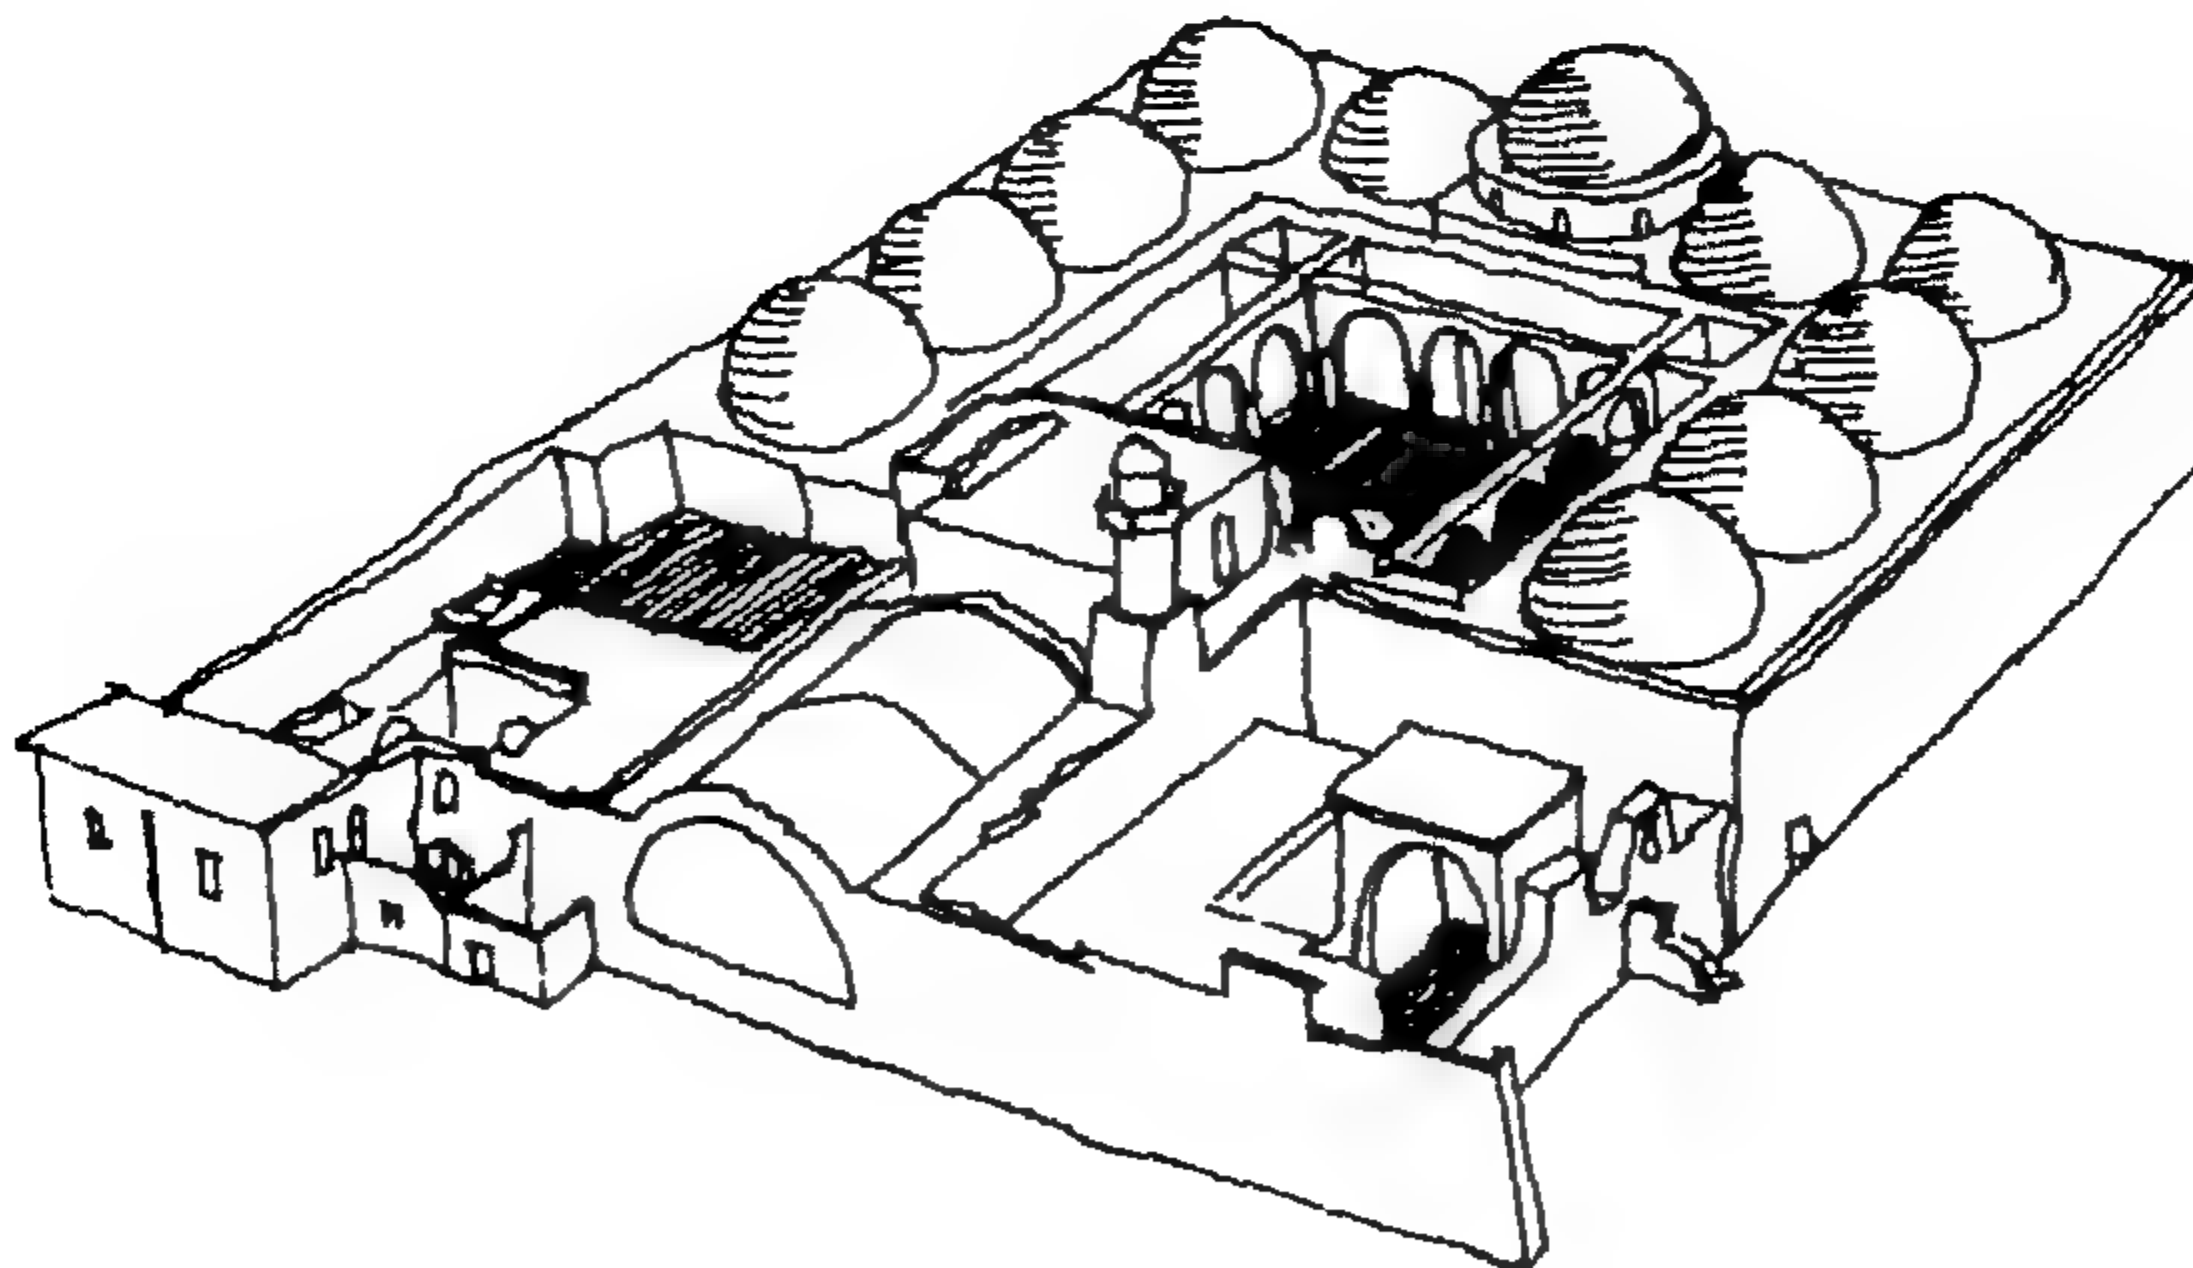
مسقط أفقي للمدرسة النورية في دمشق ٥٦٧هـ/١١٧٢م. (عن: الريحاني).
